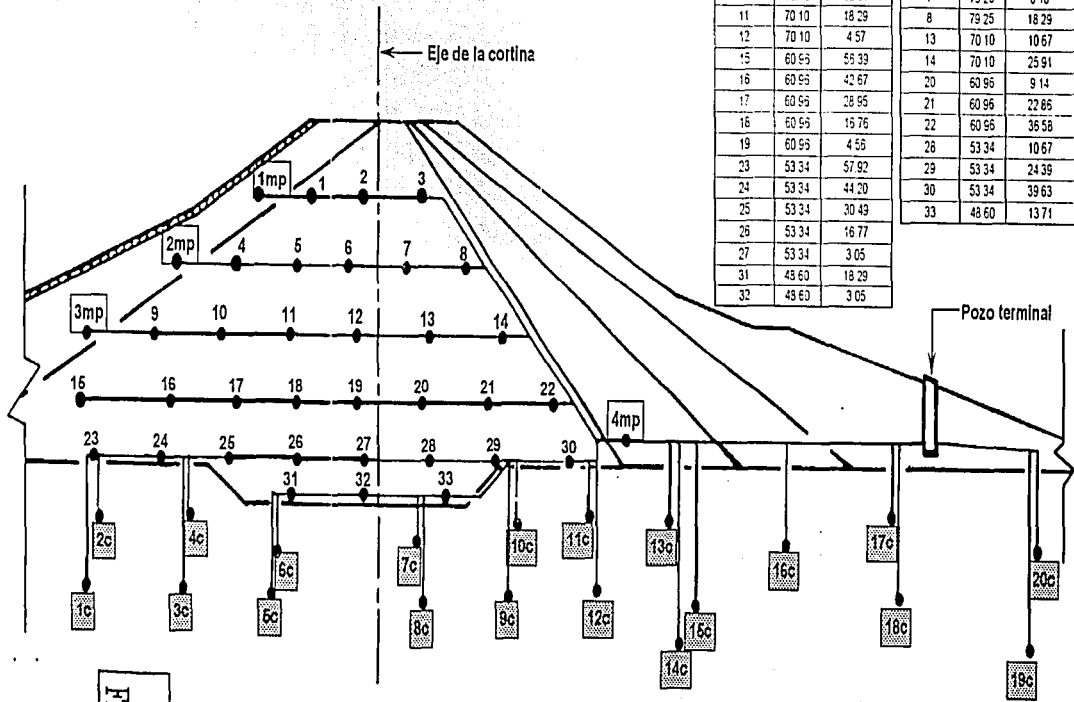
Instalación de piezómetros en la cortina de la presa Falcón.
